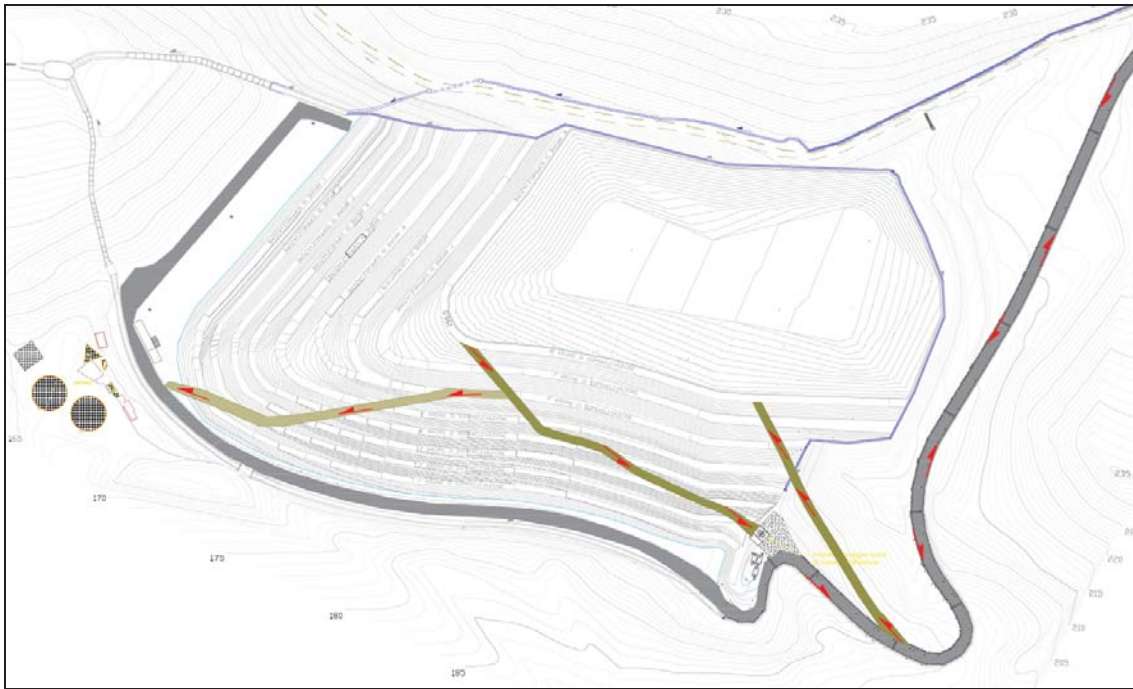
Planimetria viabilità discarica (grigio) con indicazione delle piste d'accesso al corpo discarica (marron)
